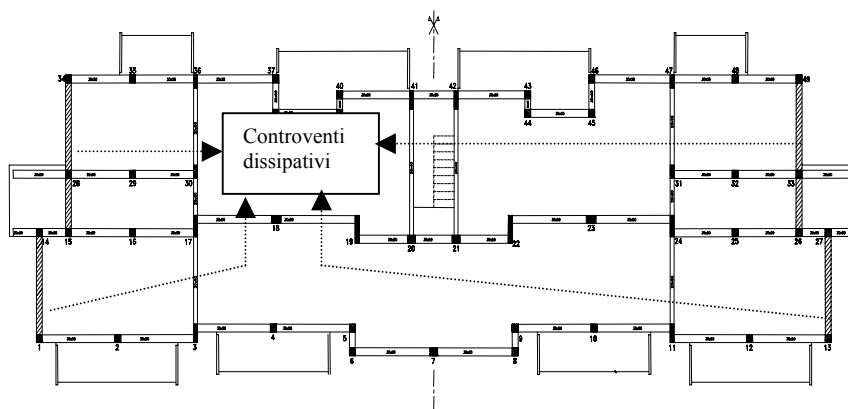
Monterosso: disposizione in pianta dei controventi dissipativi.
